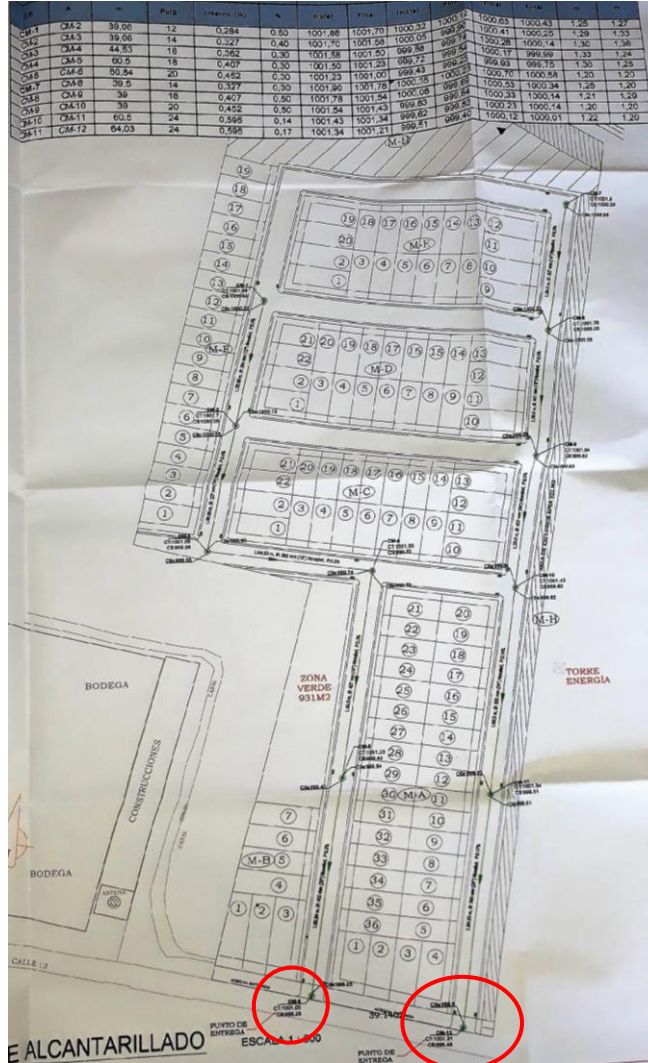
Detalle en planta del alcantarillado y de la localización de las cámaras sobre la acequia Sabaletas.
